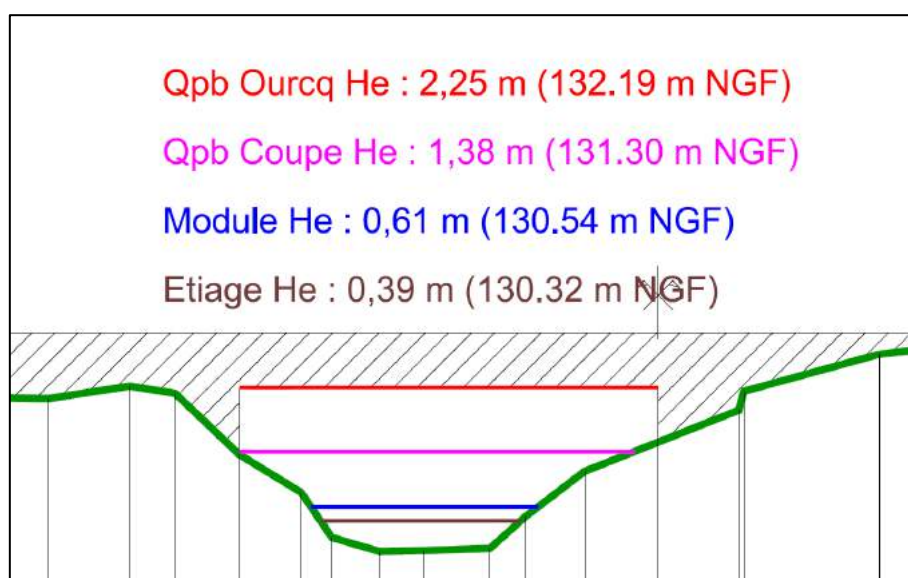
Profils en travers PT02 sur l'Ourcq aval (au droit du pont D809)
